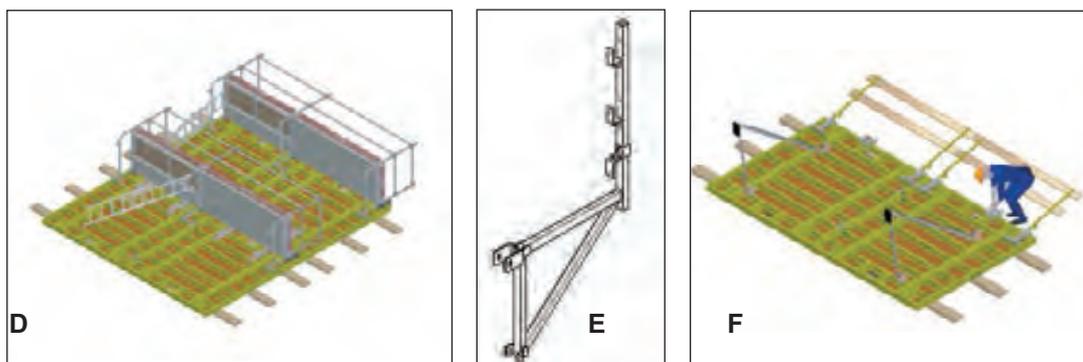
Encofrado modular. Fases de montaje D, E y F
